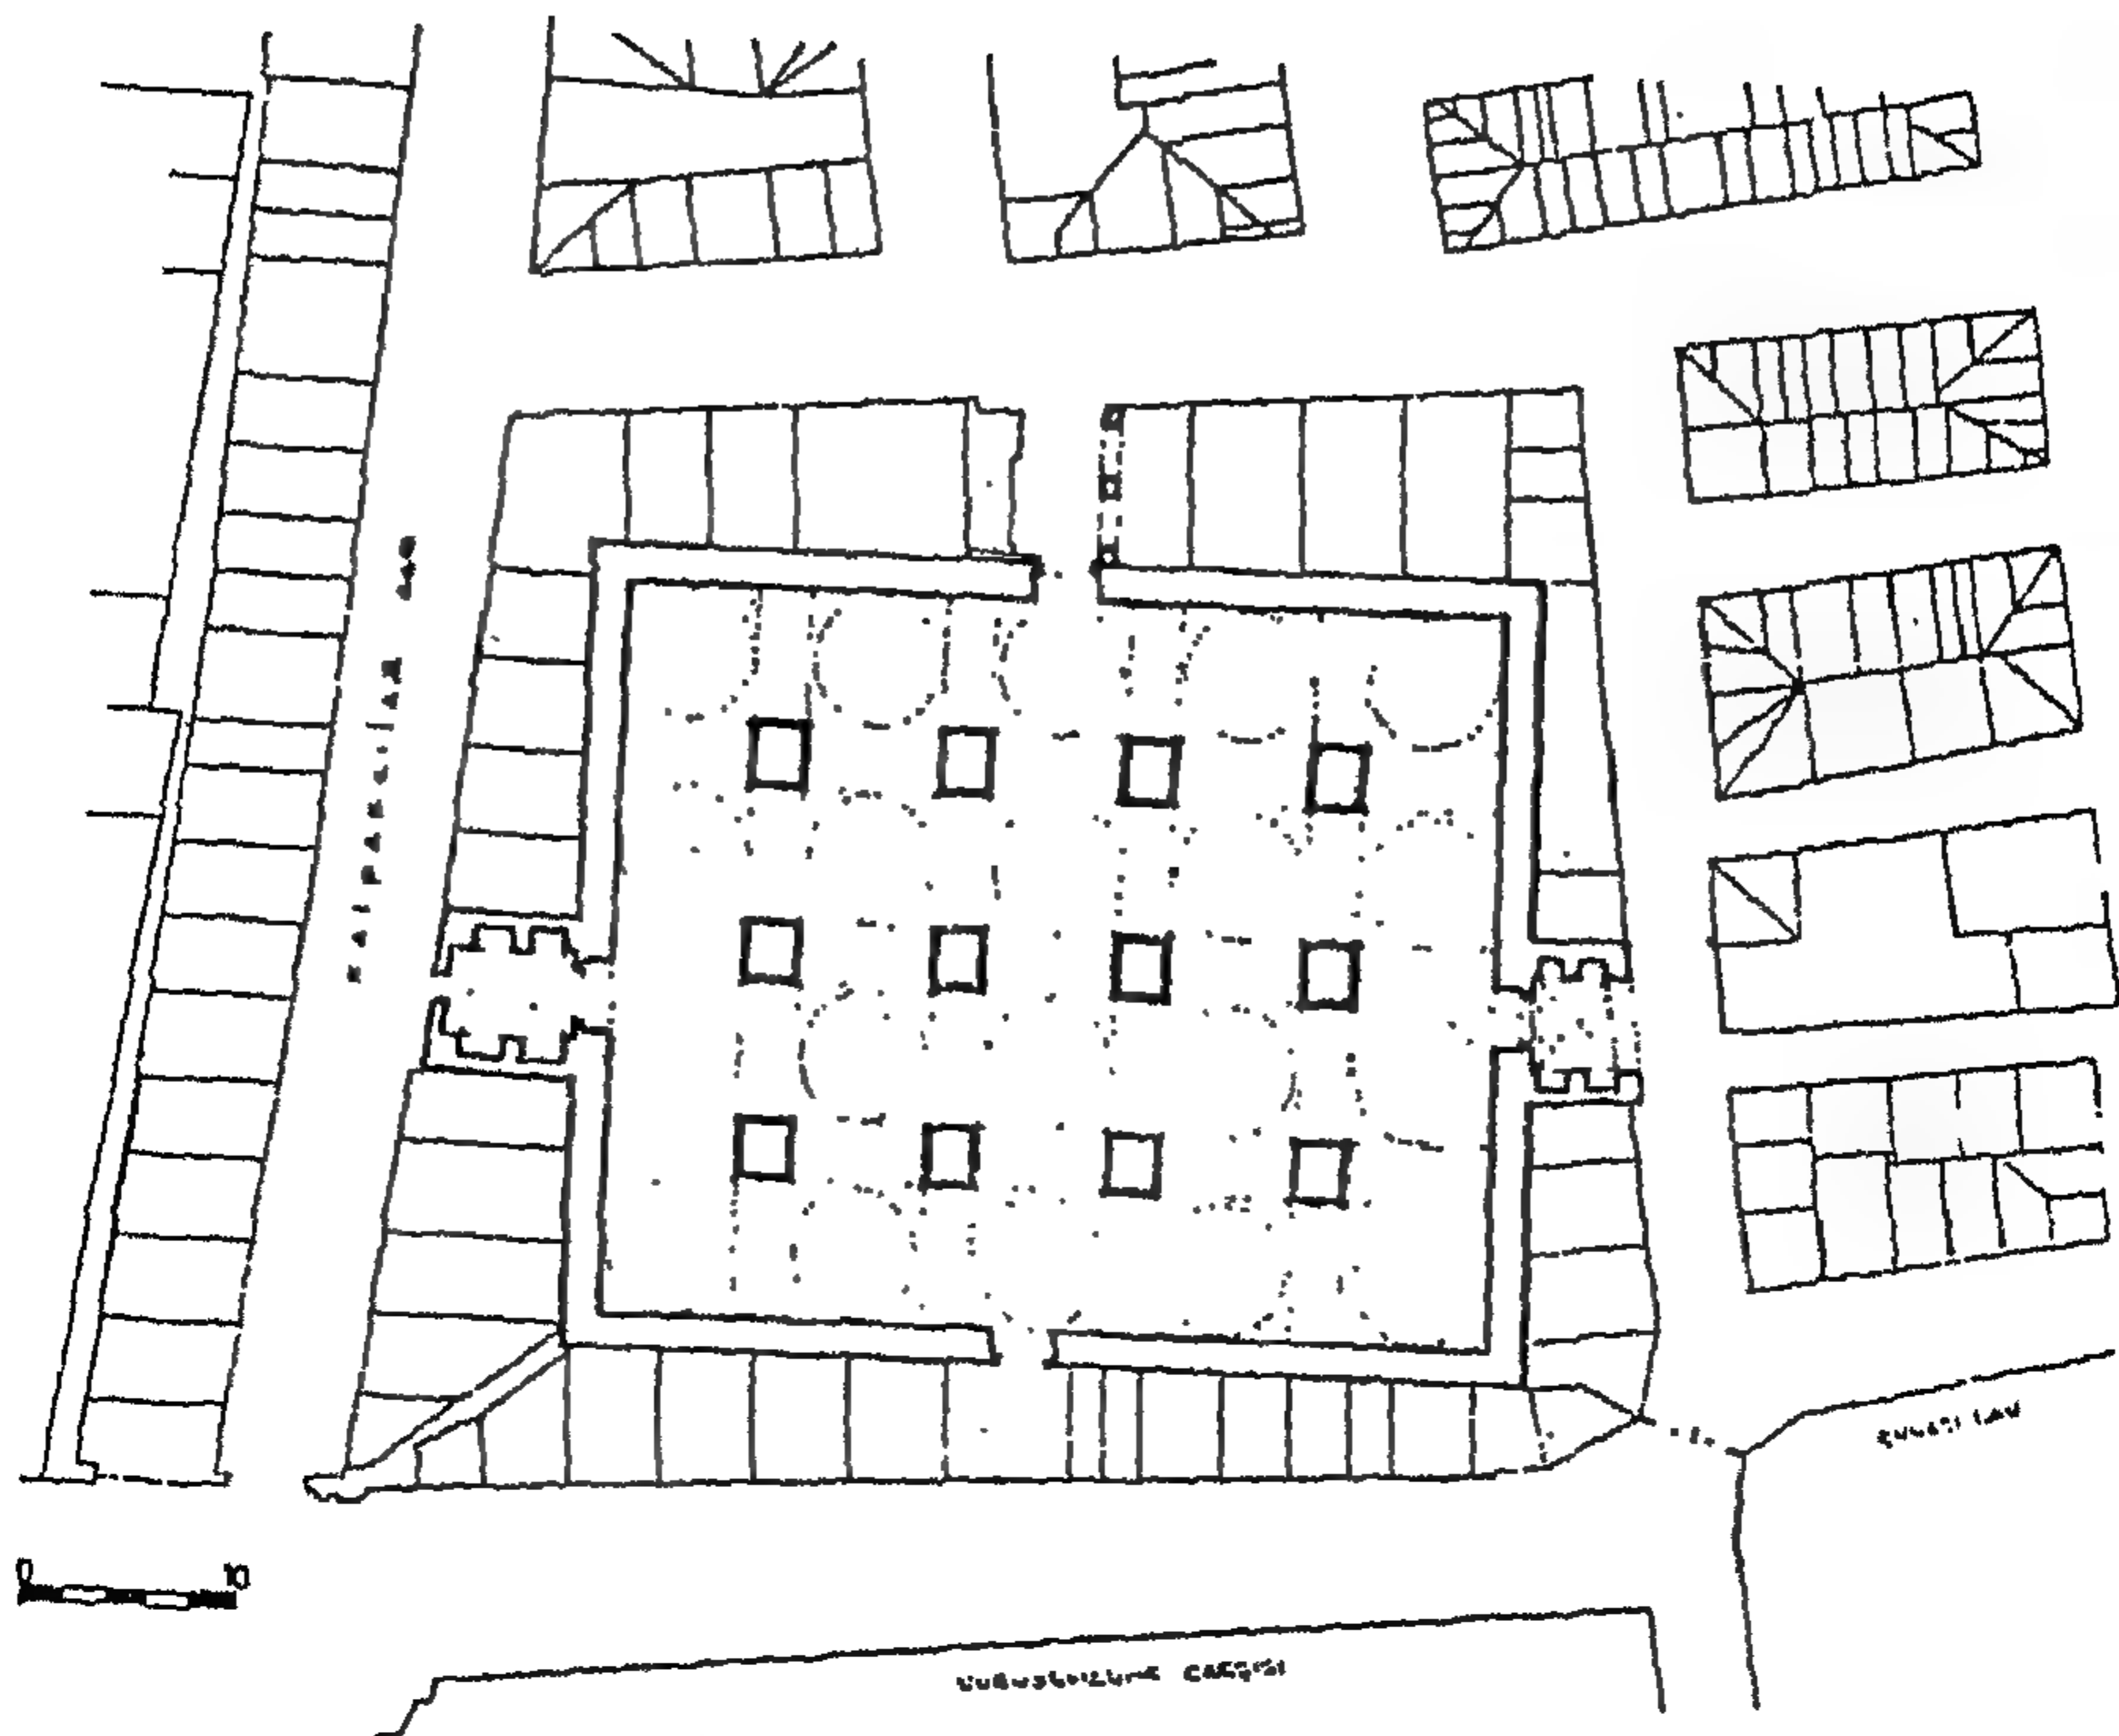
مسقط أفقى لبادستان أدرنه (عن : Cezar) .
